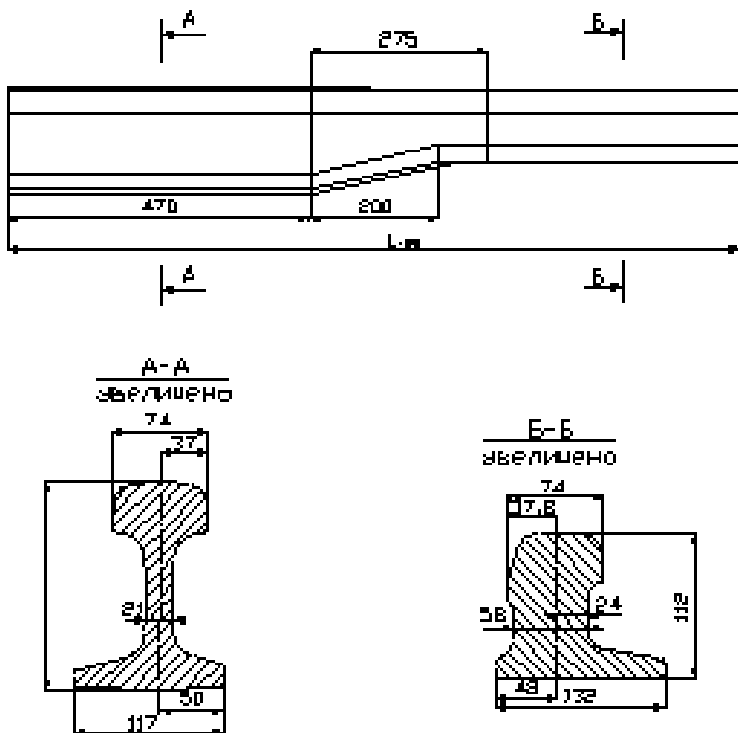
Рельс остряковый ОР50 с выпресованным корнем
